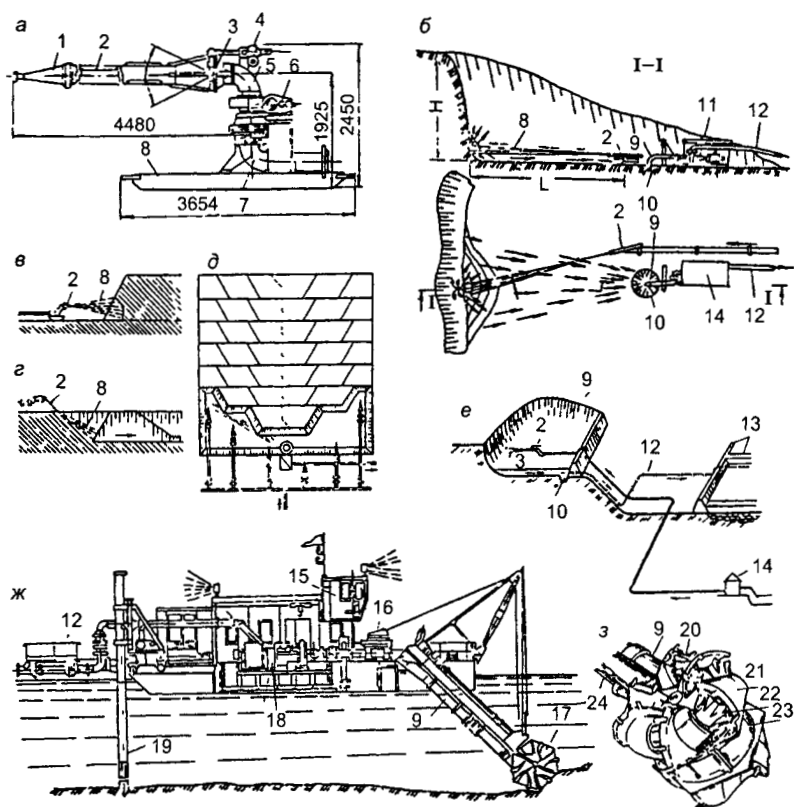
Разработка грунта гидромониторами и земснарядами:
